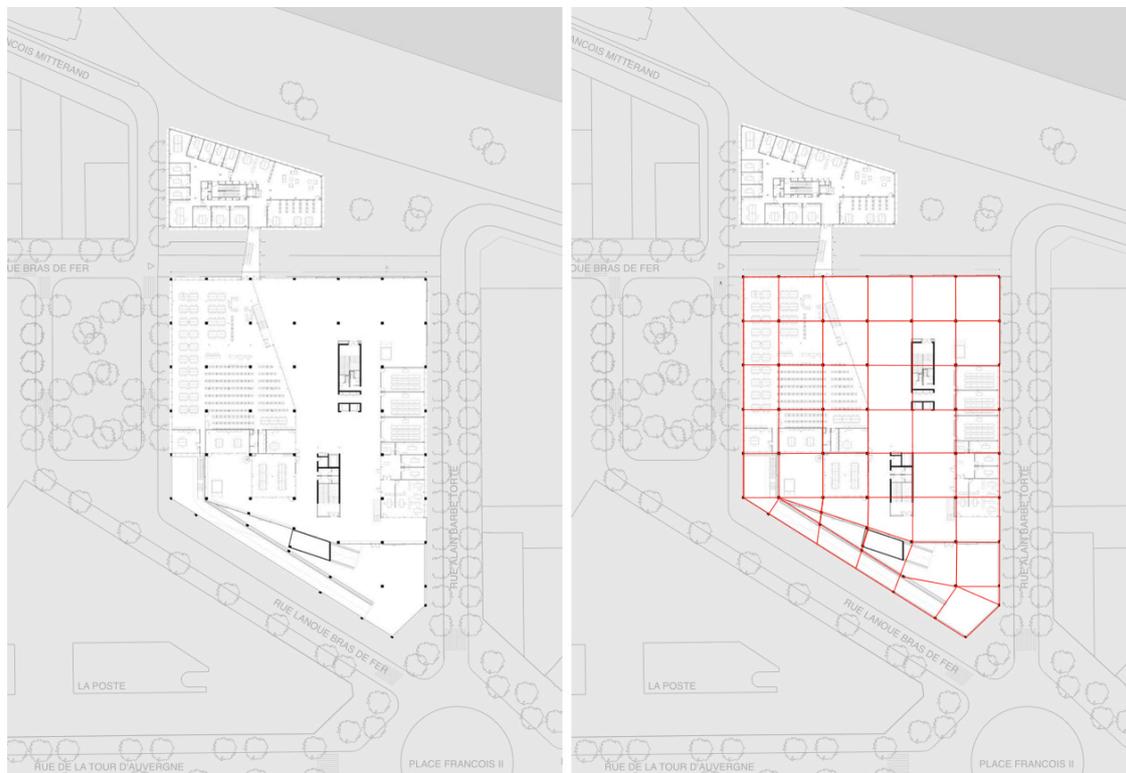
planta baixa nível 1A e planta baixa nível 1A com malha estrutural de 10x10m. editado a partir de RUBY, 2011.
